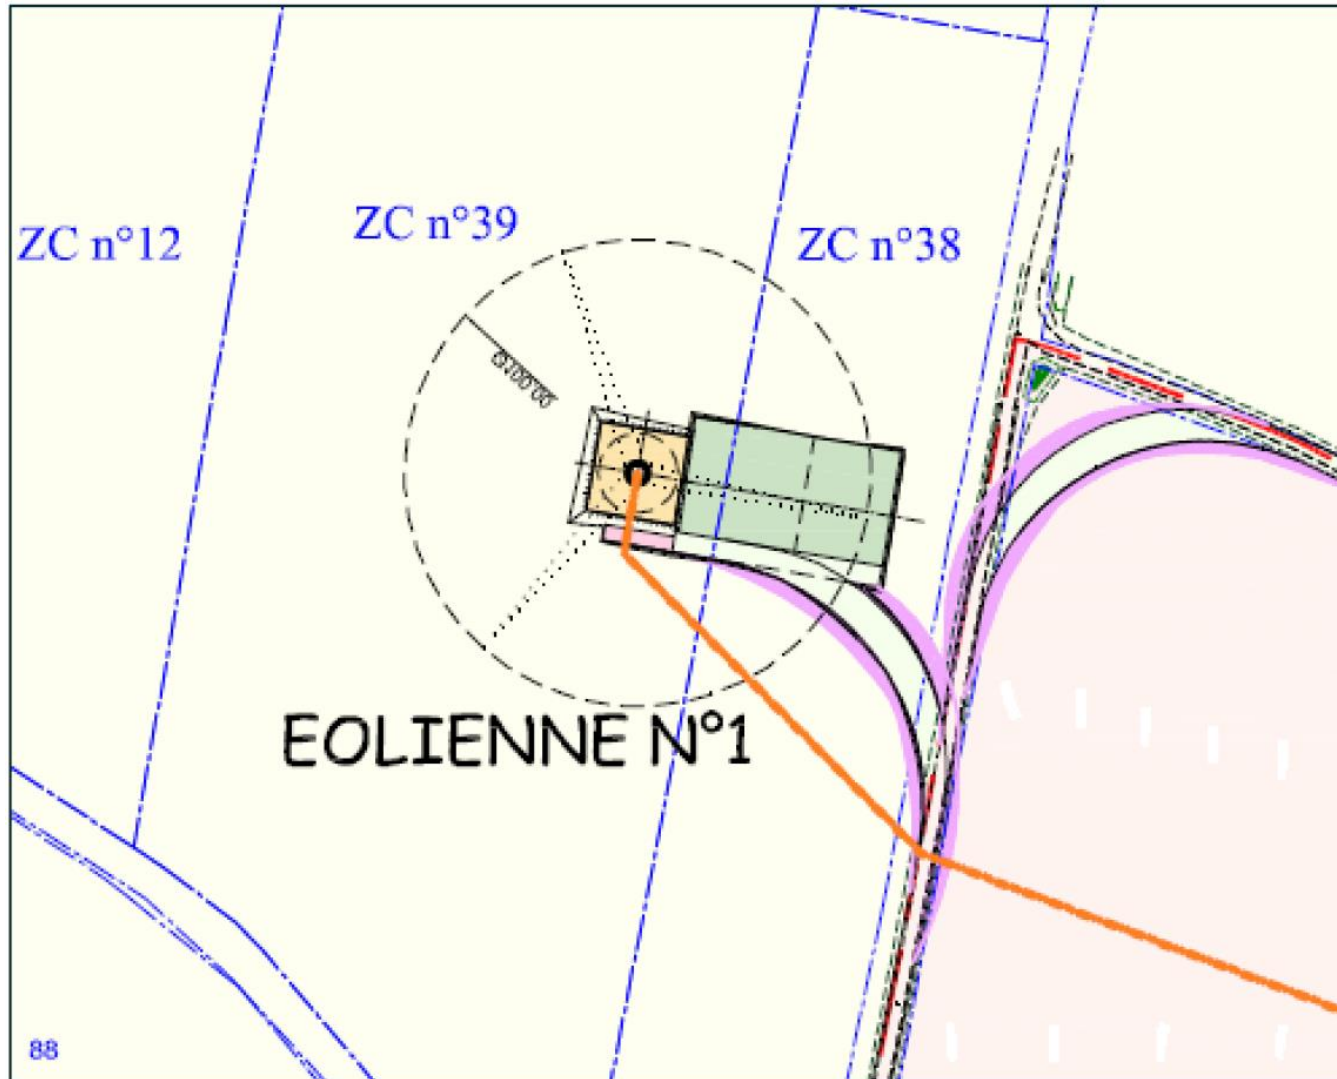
Extrait du plan AU10.2 : vue générale du projet
